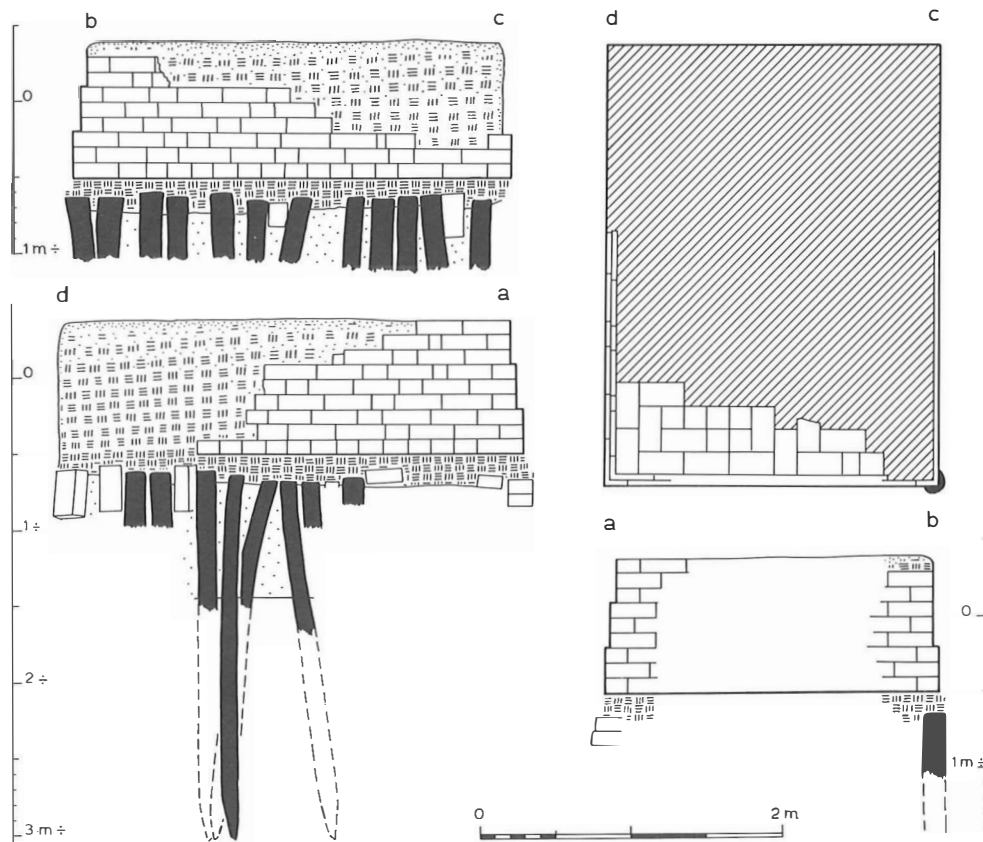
St. Bernardusabdij Aduard. Östlicher Eckpfeiler der nördlichen Querhausfassade. Grundriss und Ansichten.
